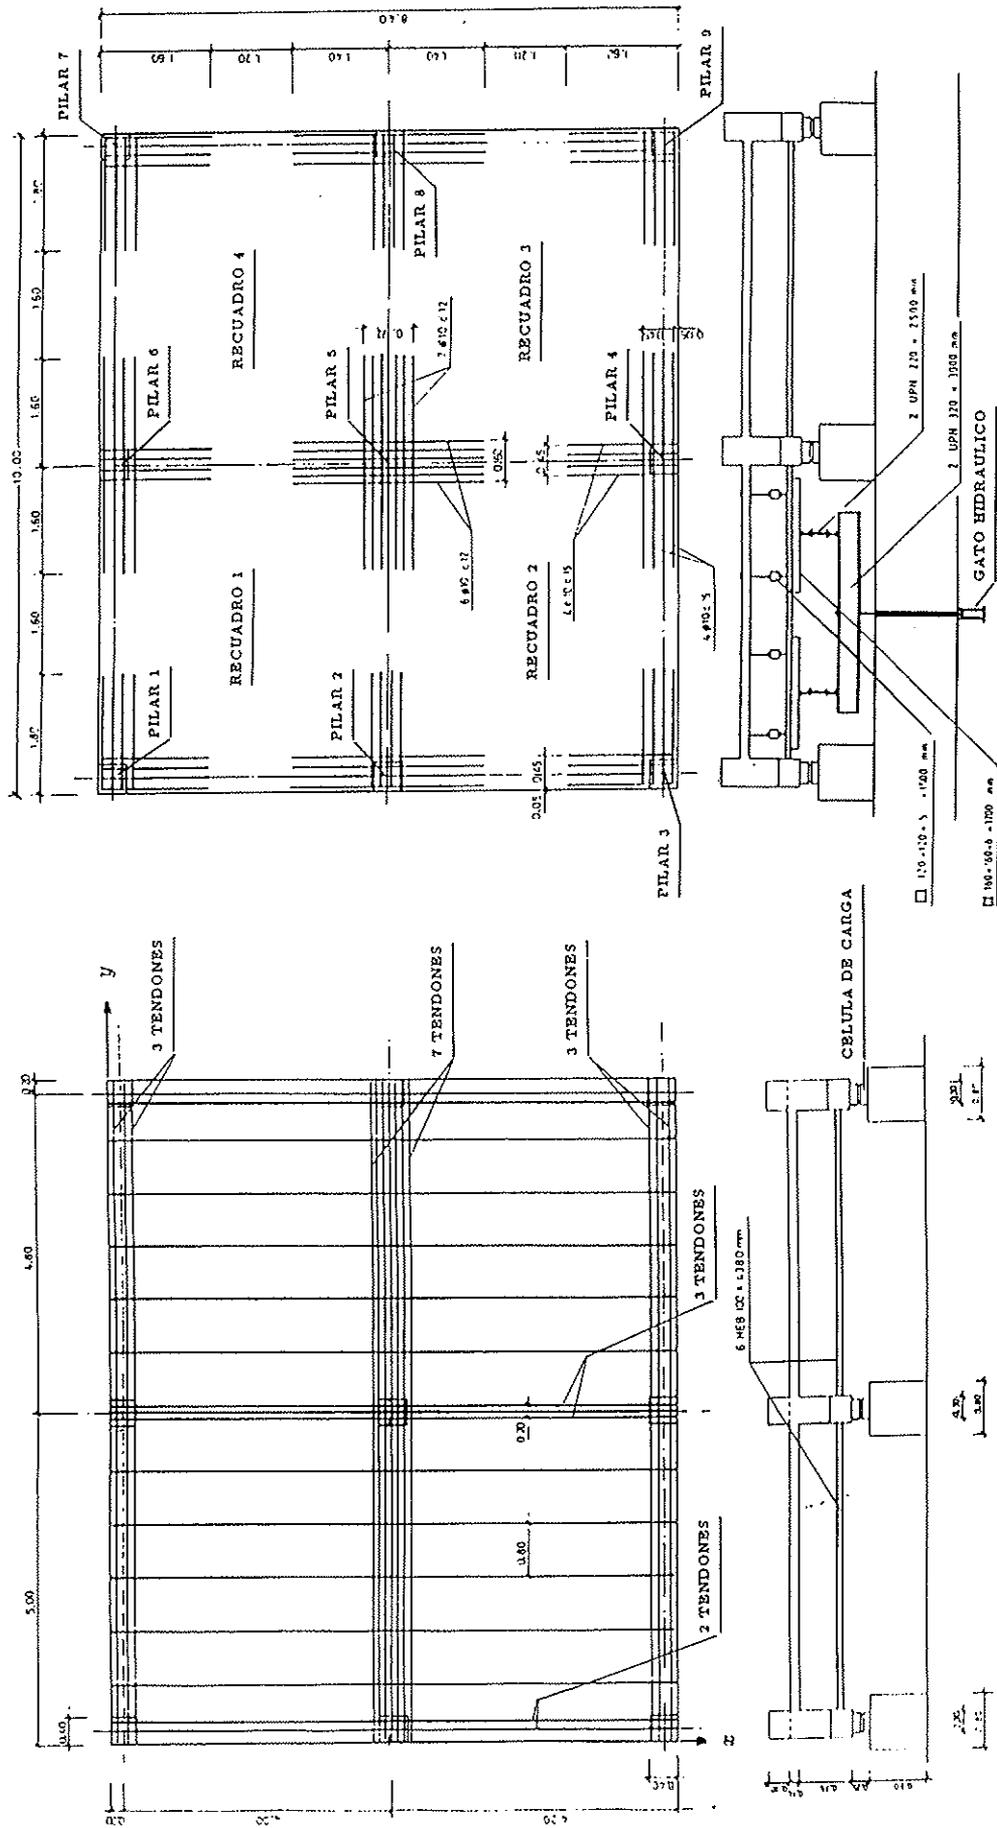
Geometria, nomenclatura, armaduras y sistema de carga.
